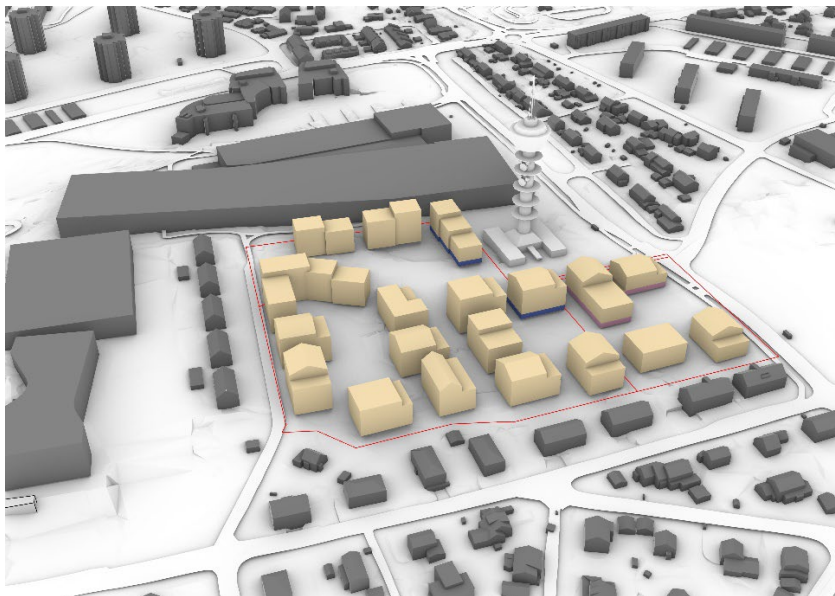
Skisse illustrasjonsprosjekt, planoversikt.
